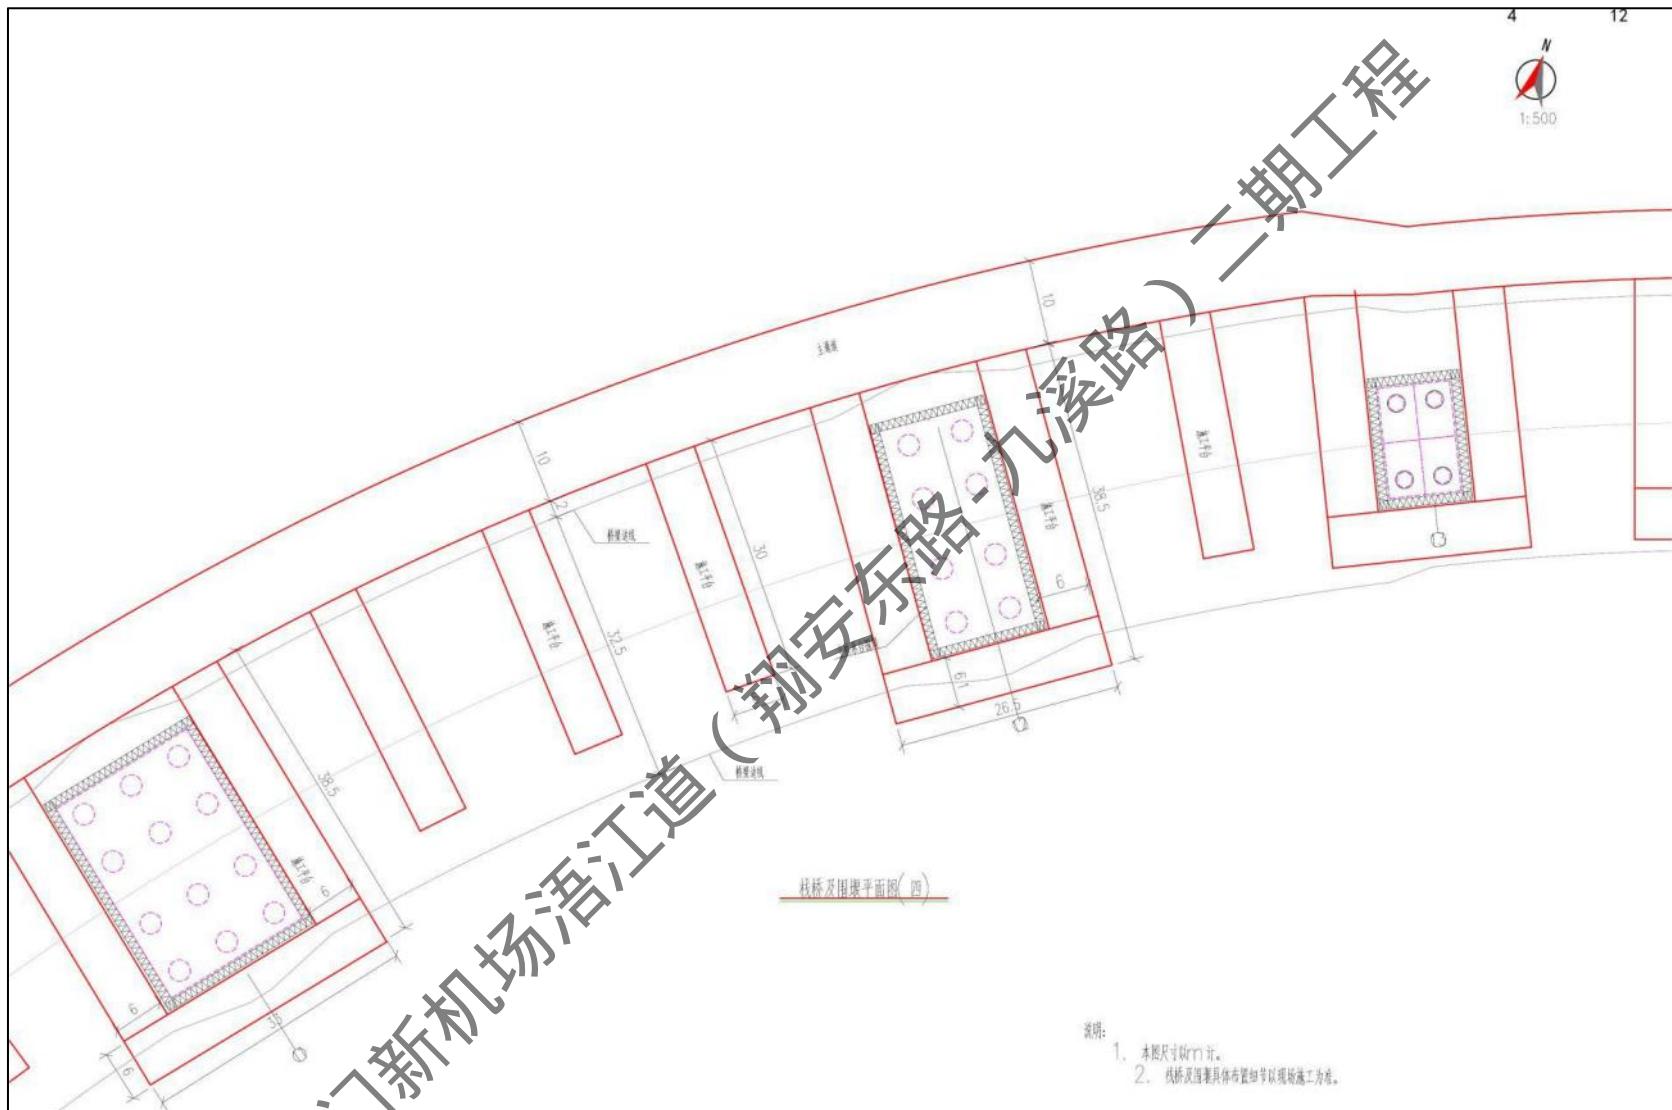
施工栈桥及围堰平面布置图（三）
